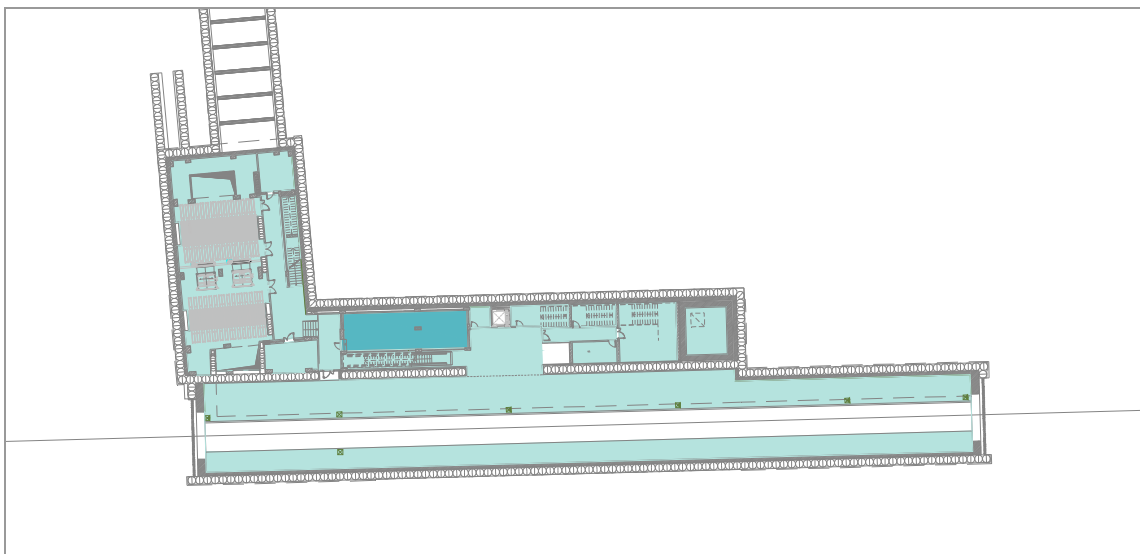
FASE 3 (Realizzazione opere interne: Pavimentazioni)
